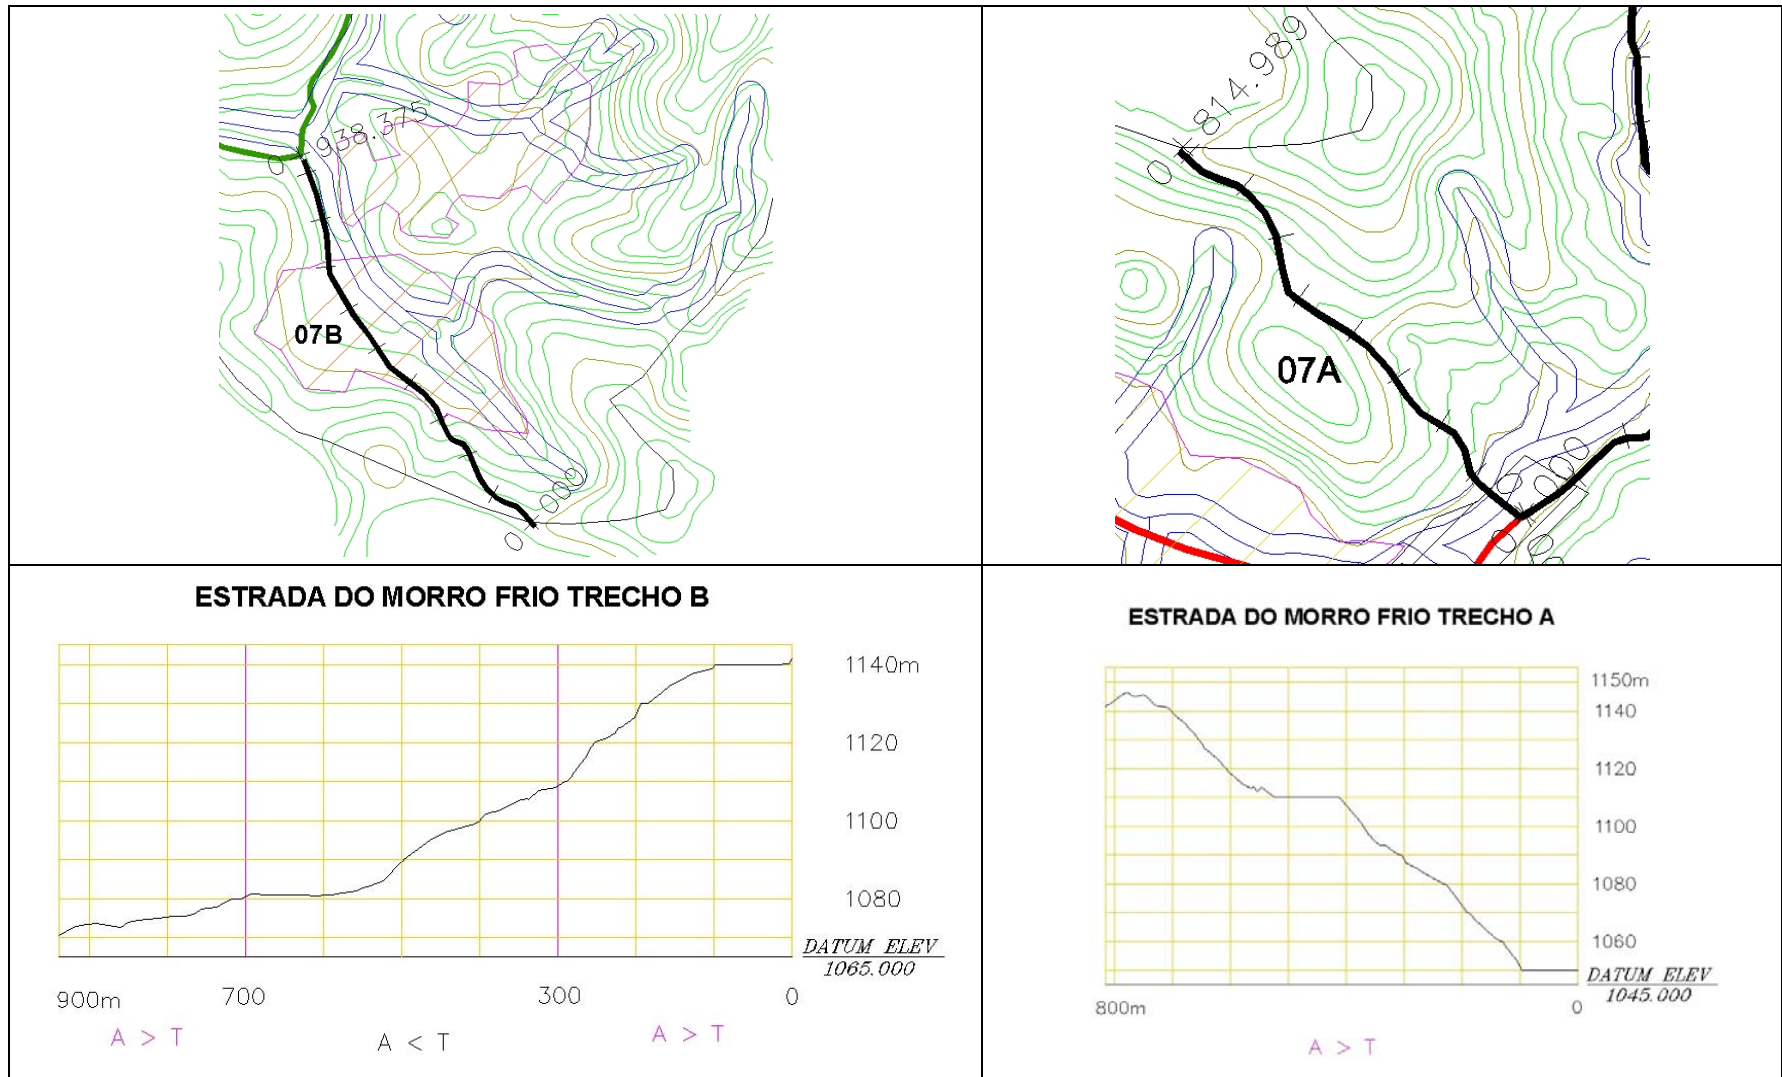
Planta e Perfil Topográfico da Estrada do Morro Frio Trechos A e B – 07A (MB5) e 07B (MB4)
